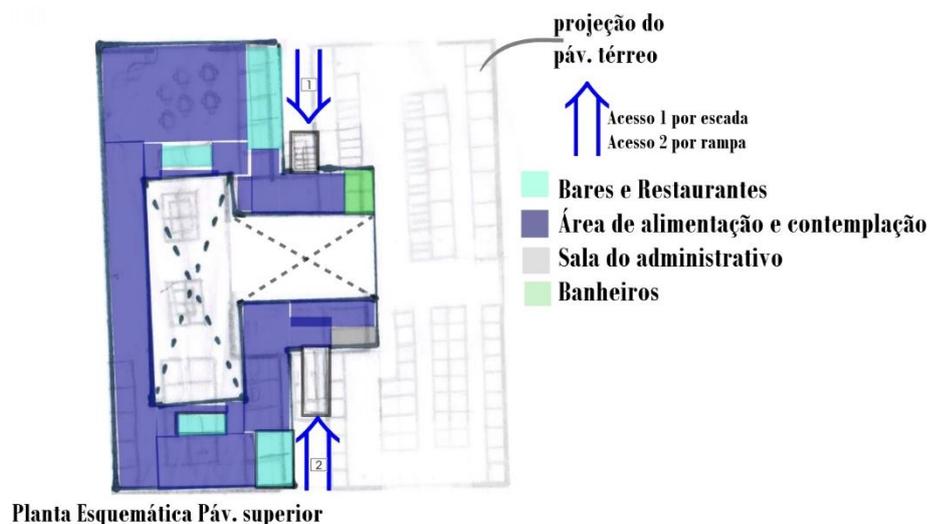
Planta esquemática pav. superior. Fonte: Bandeira, 2016.
